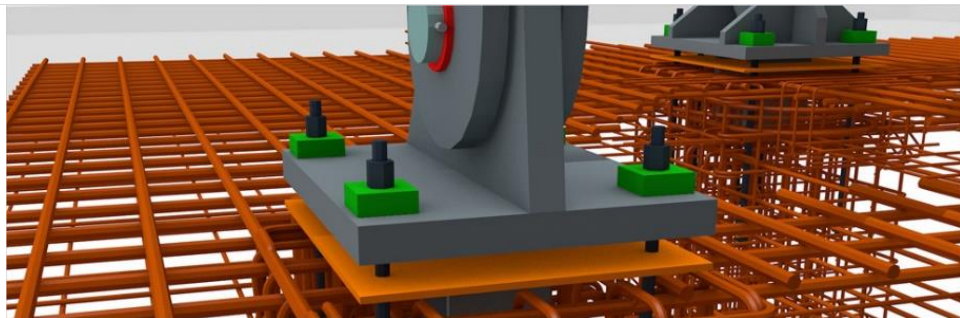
Proyecto desarrollado con ALLPLAN. Aeropuerto de Erihegy Budapest, Hungría.
